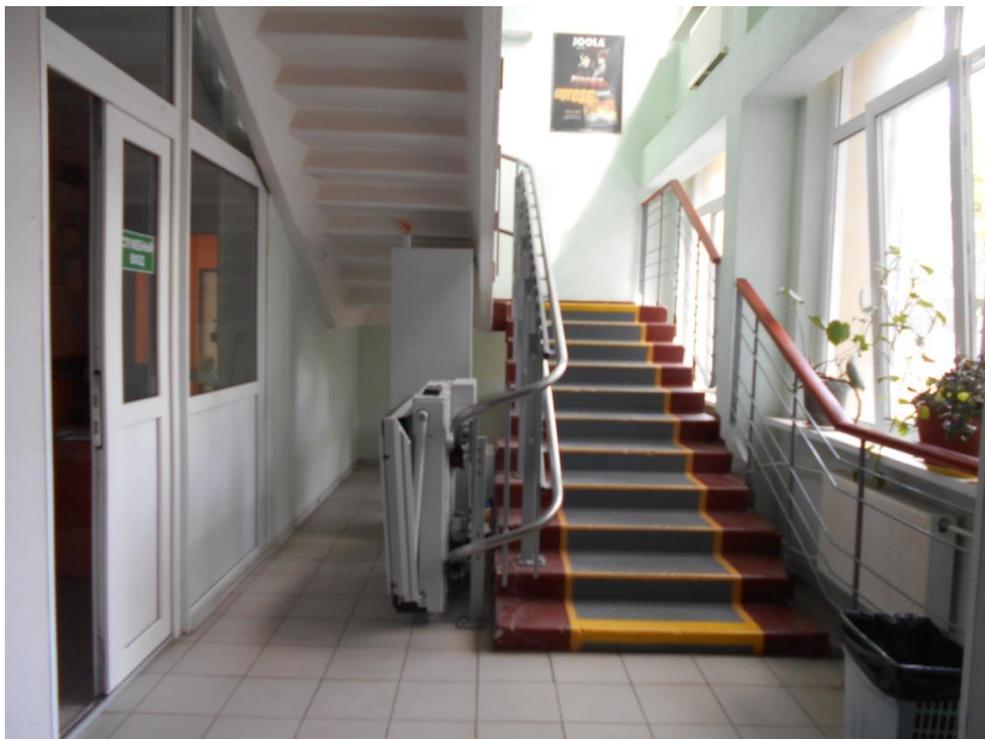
Лесенка 2ЛК. Подъемник. На плане № 14.
